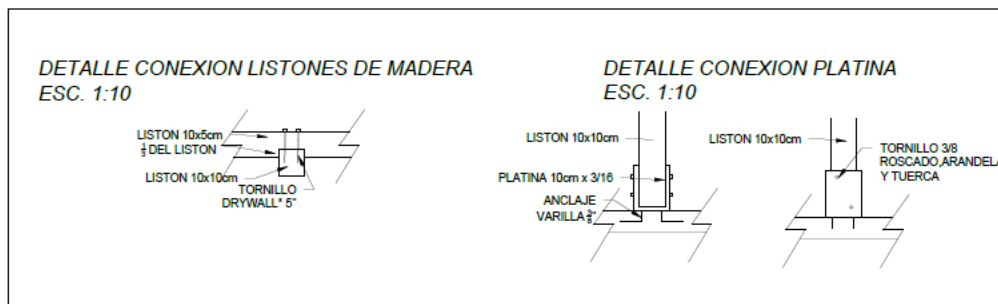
Detalle platina tipo U, para conexión de listones en madera, estructura soporte de cubierta.
